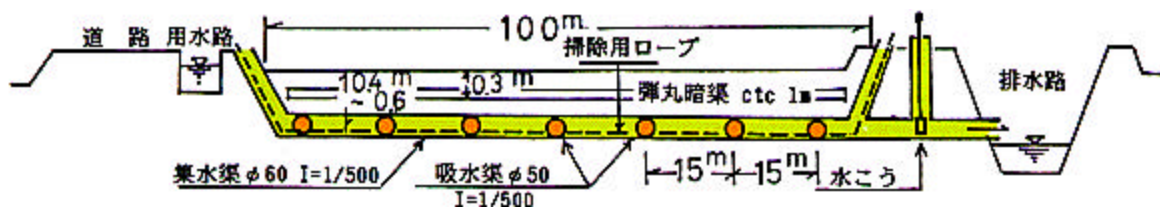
魚骨(フィシュボーン)型暗渠の縦断面図
